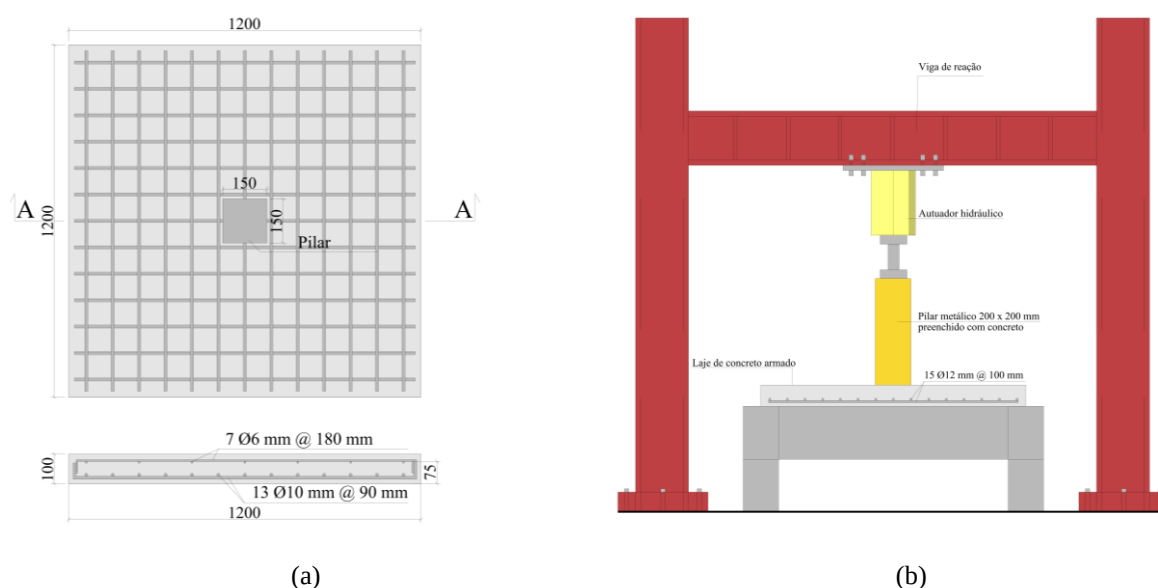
Características das lajes ensaiadas e sistema de ensaio (adaptado de Xiao *et. al.*, 2019).
